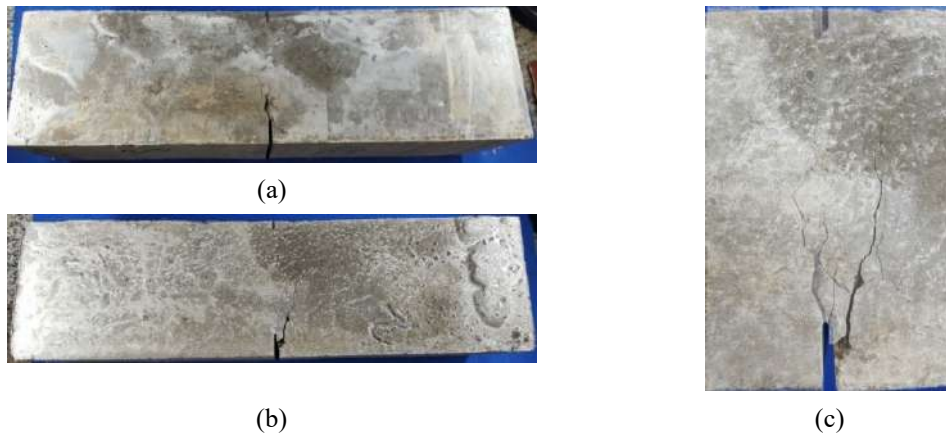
Assimetria do padrão de fissura em corpos de prova prismáticos com dimensões 10x10 x 40 cm³: (a) frente do corpo de prova, (b) verso do corpo de prova, e (c) sobreposição das fissuras.
